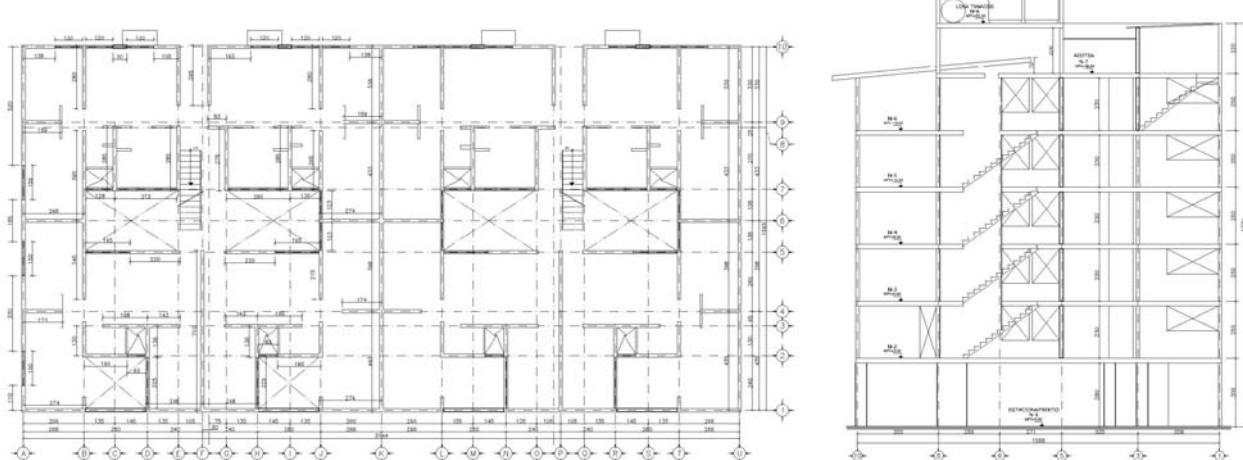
, PROPIEDADES PLANTA DE NIVEL 2 Y CORTE EN EJE P
